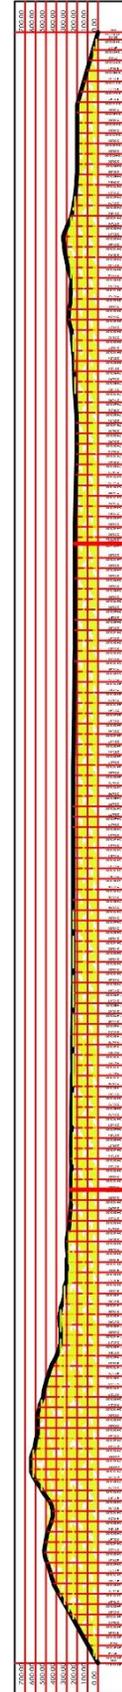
Perfil del terreno. Fuente: Elaboración propia
